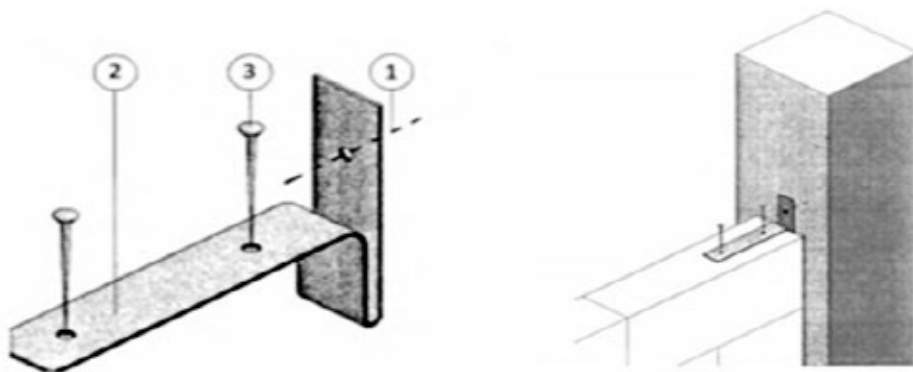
Типове технічне рішення фіксації газобетонної стіни до колон будівлі.
